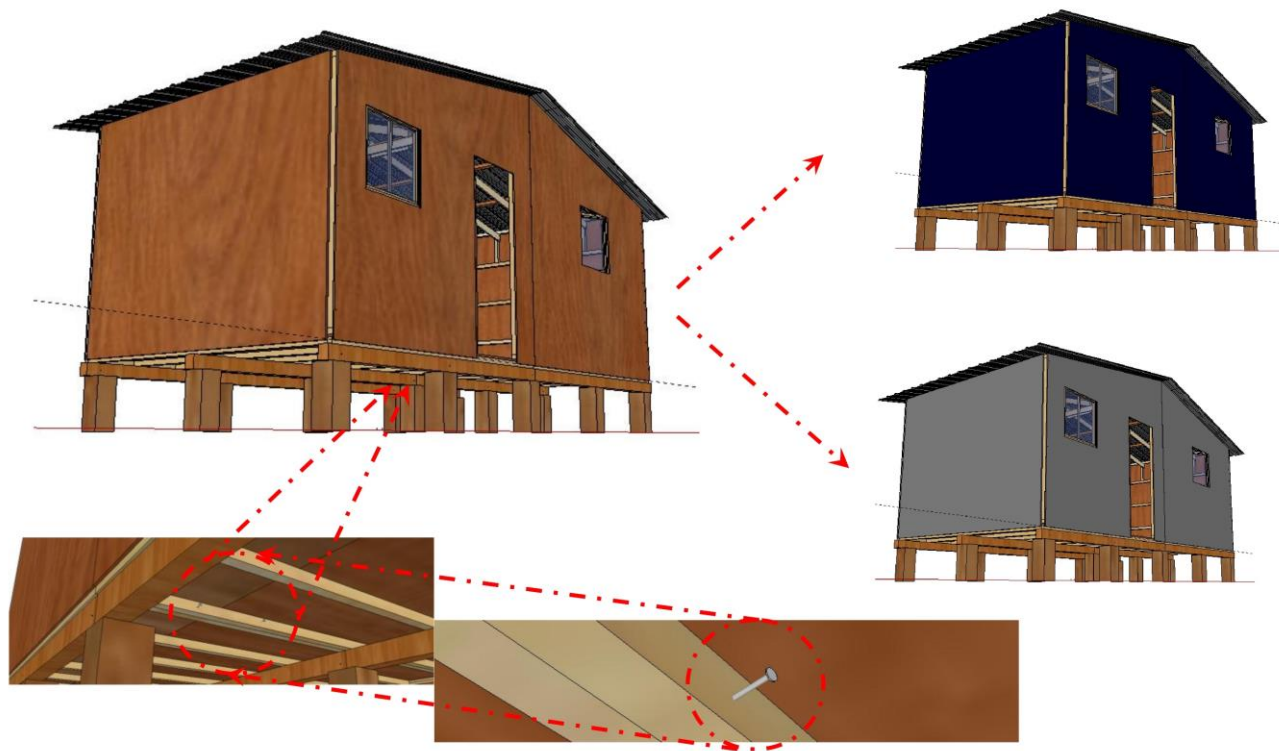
Culminación de la construcción, Fuente: Manual para la construcción - TECHO
